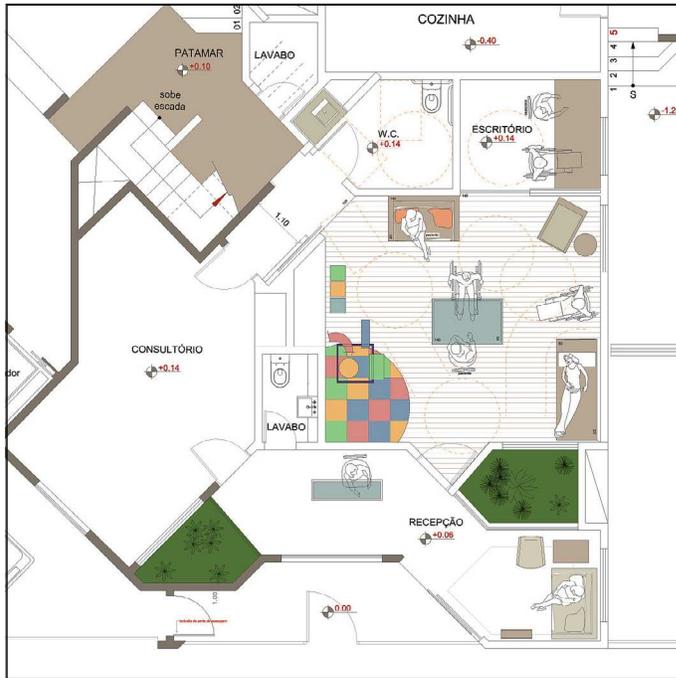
planta do 1º estudo preliminar para a área do consultório. FONTE: acervo do projetista
